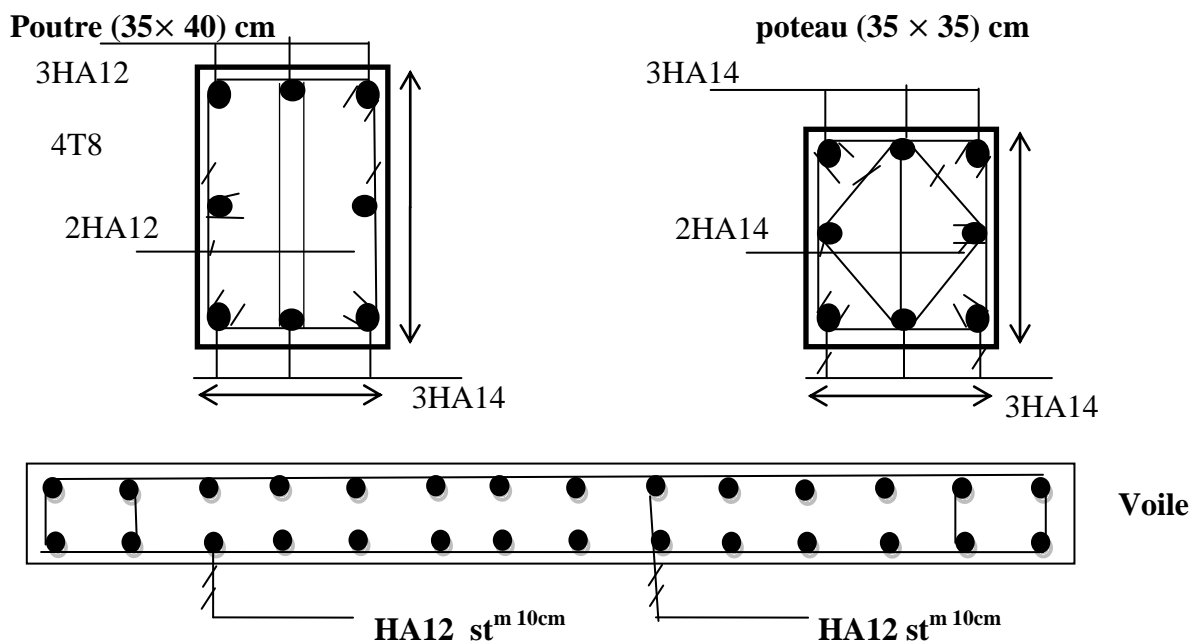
Dimension des sections de béton des poutres et des poteaux et des voiles des deux structures.
